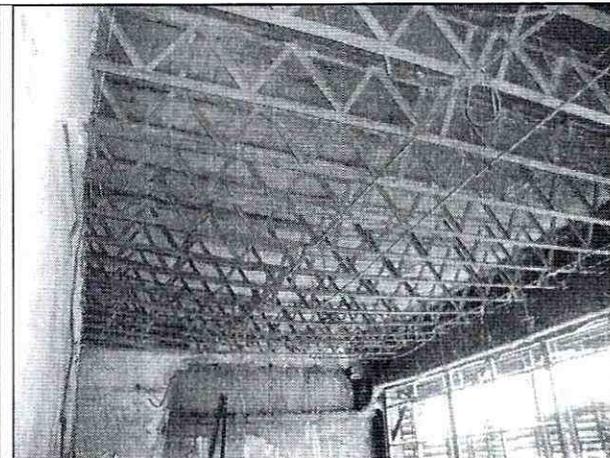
Tipología de la estructura metálica sobre la que se apoya la losa de cubierta (terracea, nivel 23).
